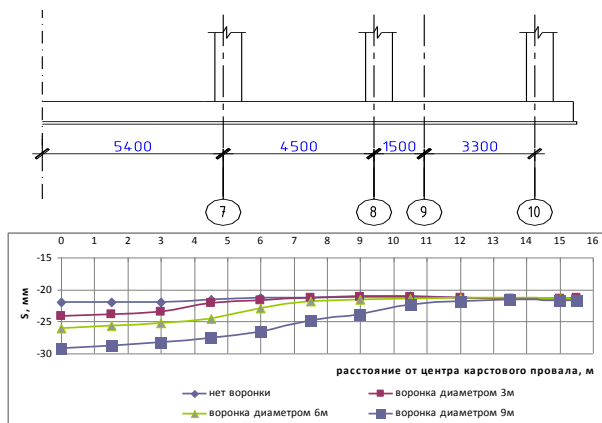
Осадки основания под фундаментной плитой здания с учетом образования карстовой воронки
